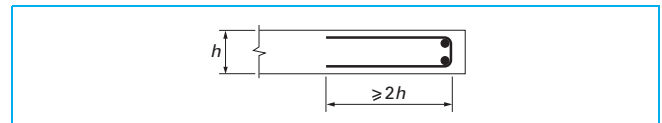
Armatures de bord d'une dalle (figure 9.8 de l'EC2)
